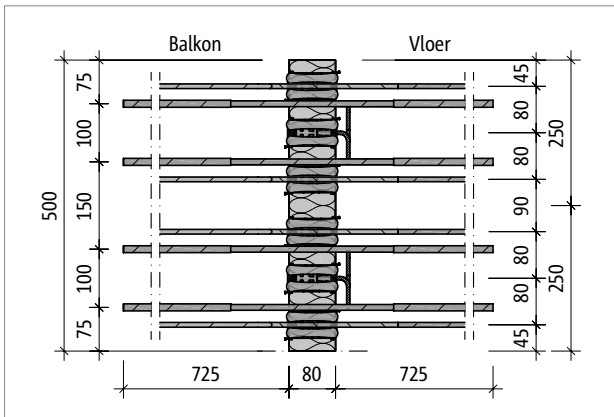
Schöck Isokorf® T type K-T-M10-V1: Bovenaanzicht
